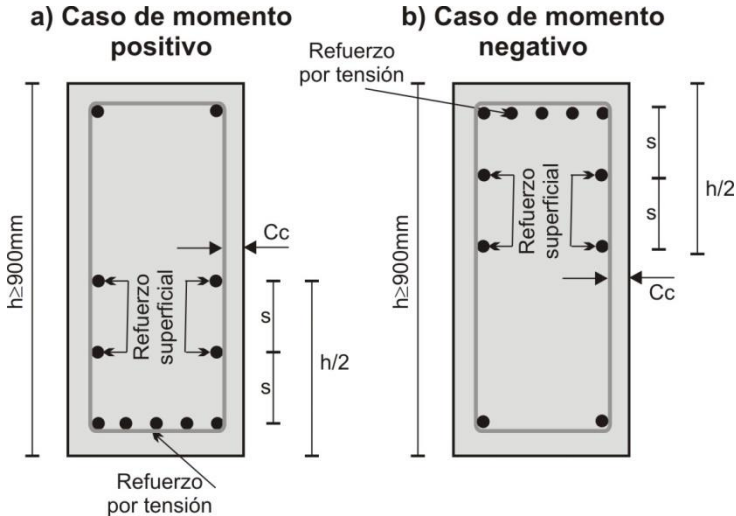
Refuerzo superficial para vigas con $h \geq 900$ mm.
